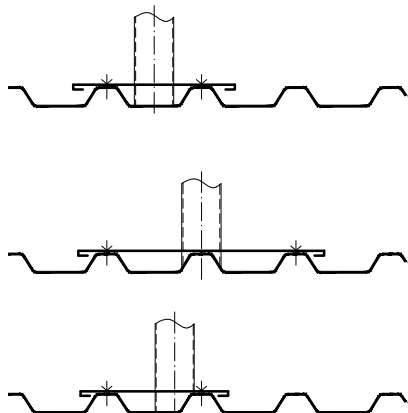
DETAIL PRESTUPU CEZ STREŠNÝ PLÁŠŤ
